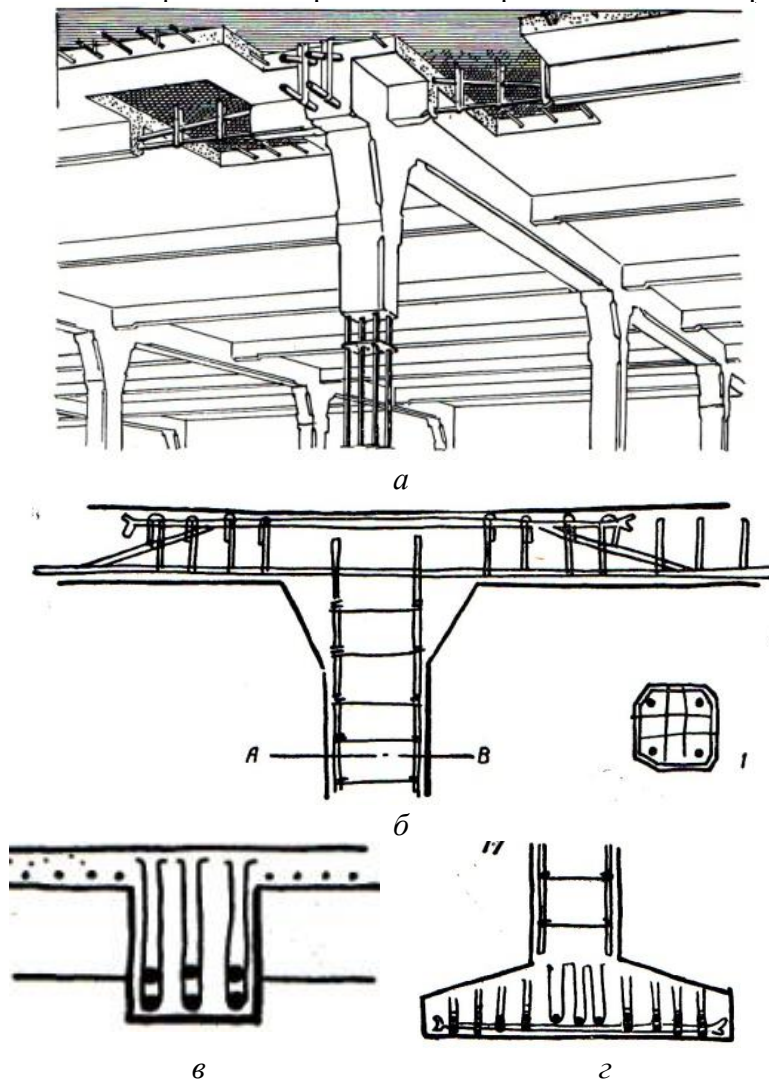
Система каркасної монолітної будівлі з ребристими перекриттями Ф. Геннебіка, 1892 р.:
